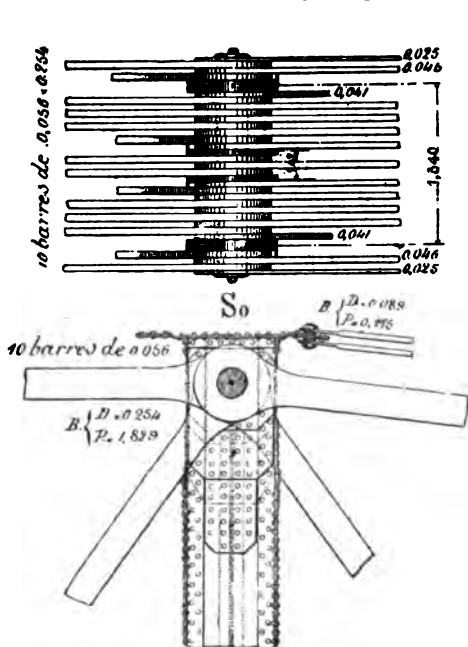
Pont de Memphis (Nœud sur la pile II).
